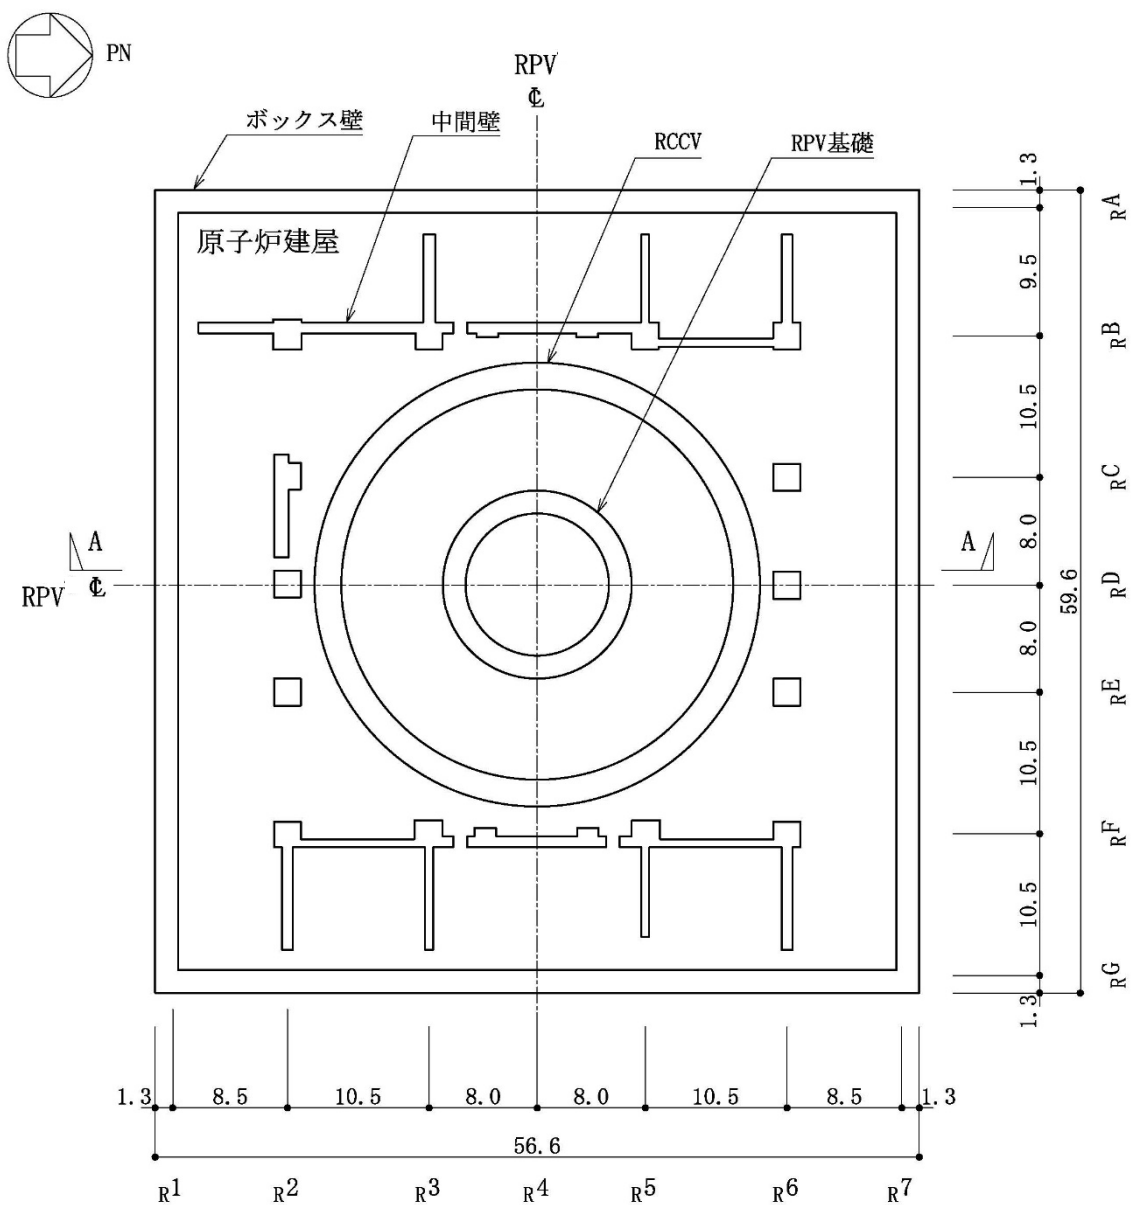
原子炉建屋基礎スラブの概略平面図 (T.M.S.L. -8.2m) (単位 : m)
